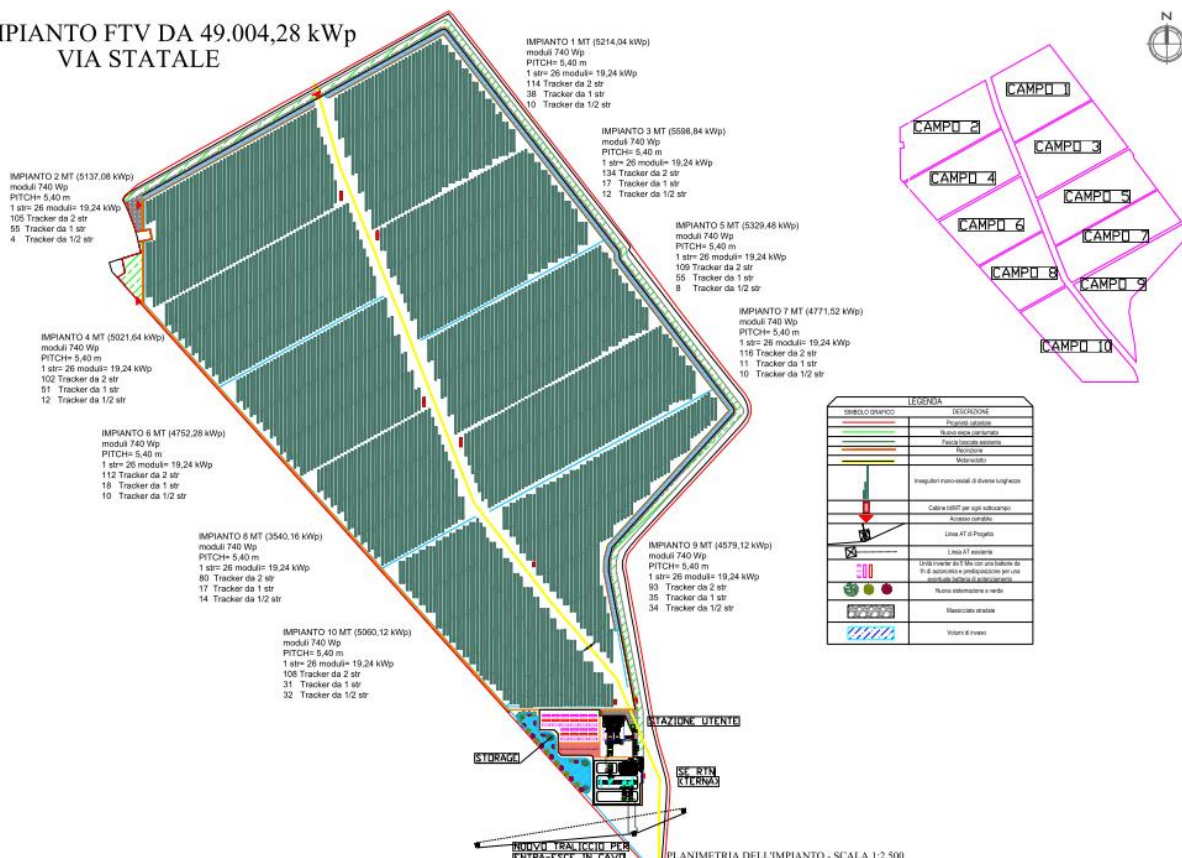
Planimetria del parco fotovoltaico con localizzazione dell'area in cui dovrà sorgere la stazione
